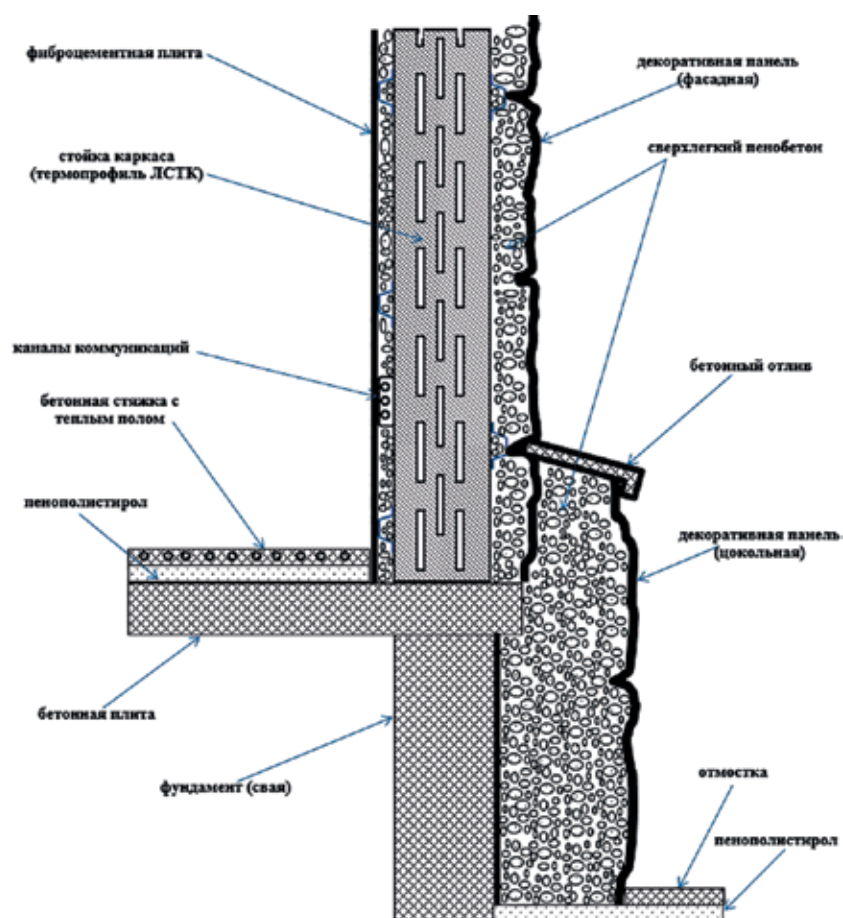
Узел примыкания несущего каркаса из ЛСТК к фундаменту.
